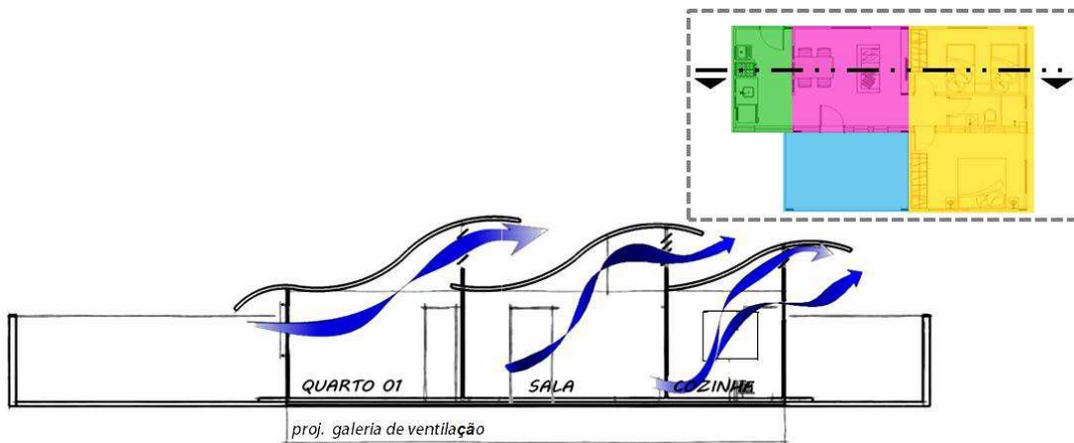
Corte Esquemático 02 – Aberturas e Ventilação Cruzada.
